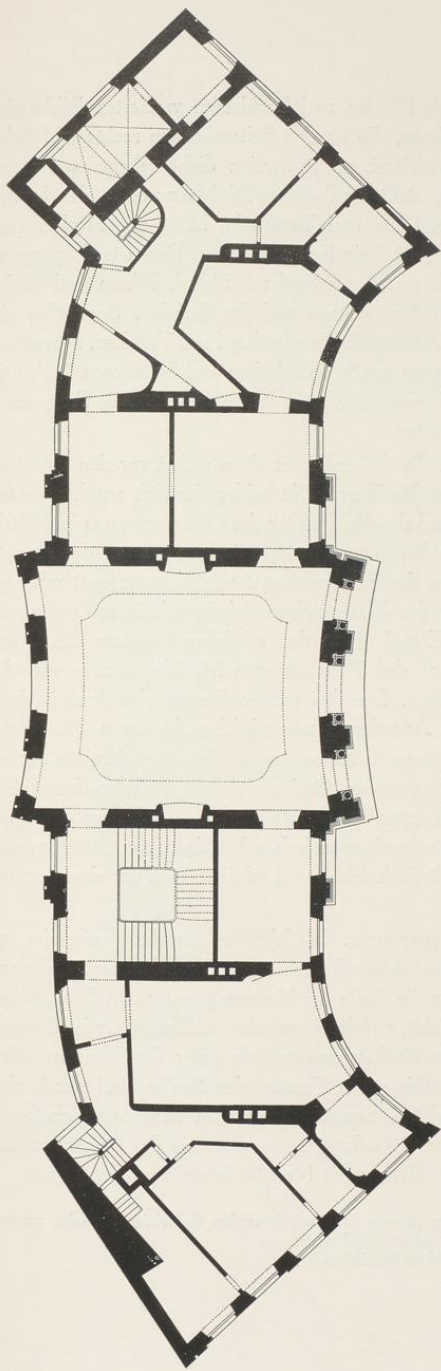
Grundriss des Obergeschosses des Erdrostenhofes. Maßstab 1 : 250
